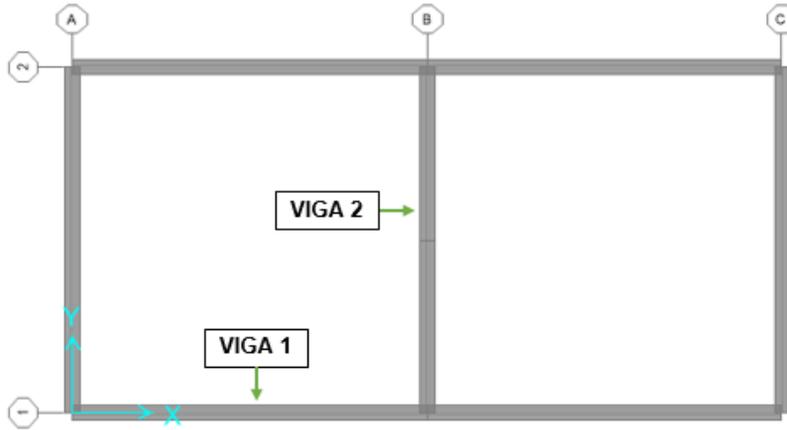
Elementos estructurales a analizar. Fuente: Propia
